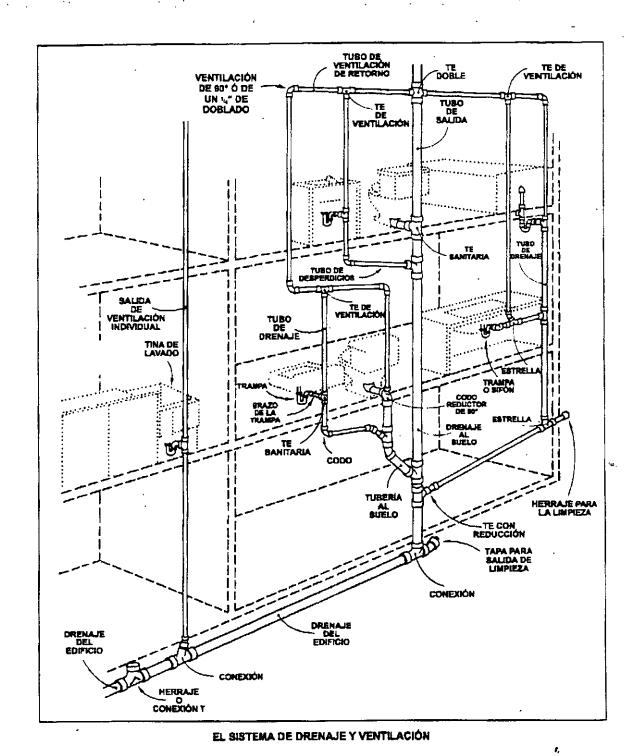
Diagrama tridimensional de un sistema de drenaje y ventilación.
